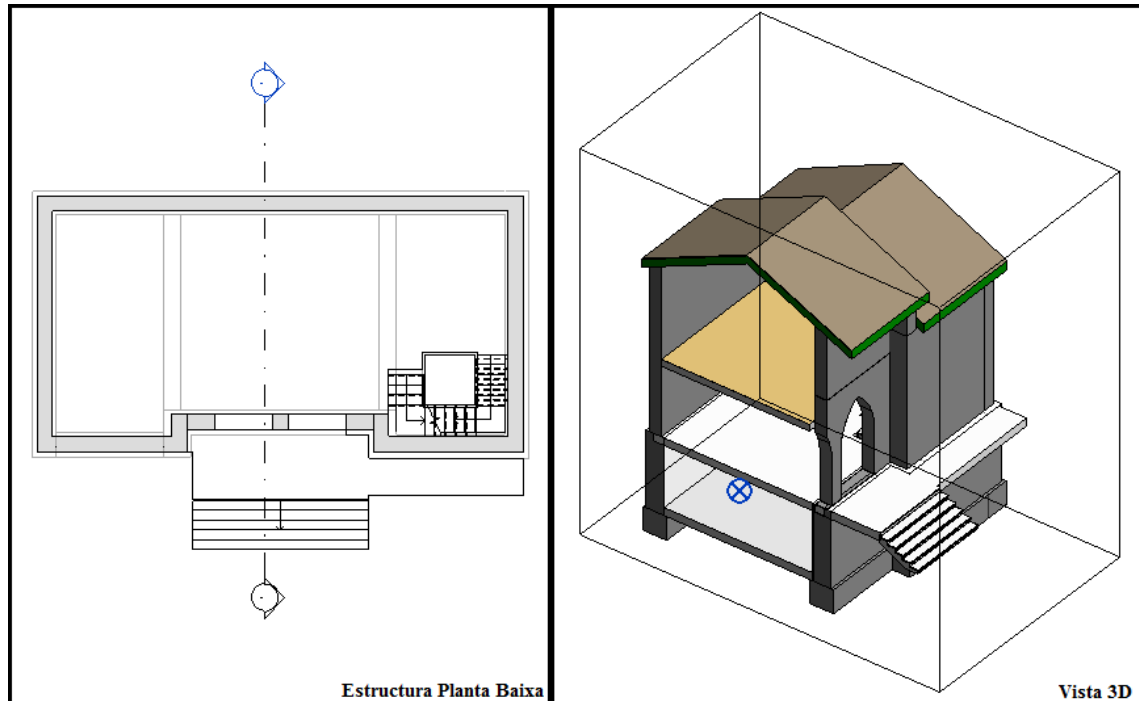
Secció en planta del modelatge de l'estructura. Font: captura software Revit 2017.
